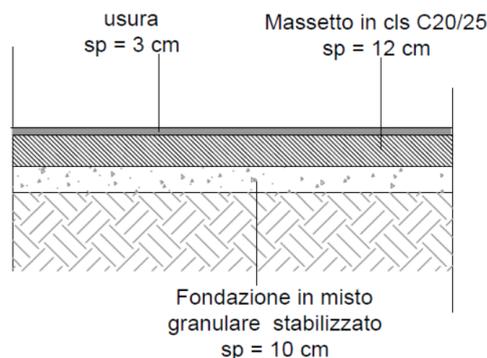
Pacchetto pavimentazione isole spartitraffico in usura
